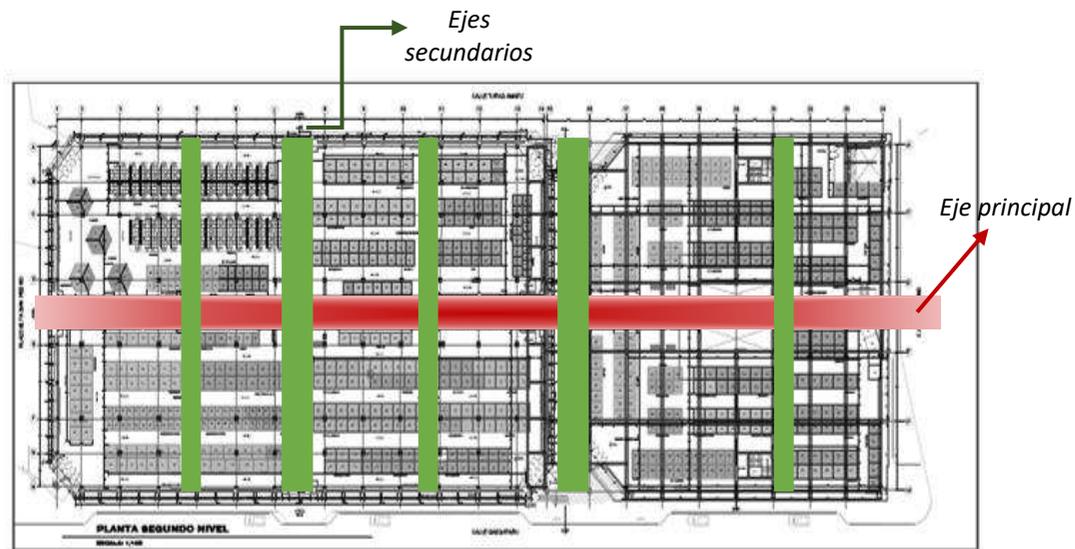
Ejes de Circulación. Fuente: graficado sobre Plano de planta del Mercado San Pedro, Gerencia de Centros Históricos de la MPC (2023).
